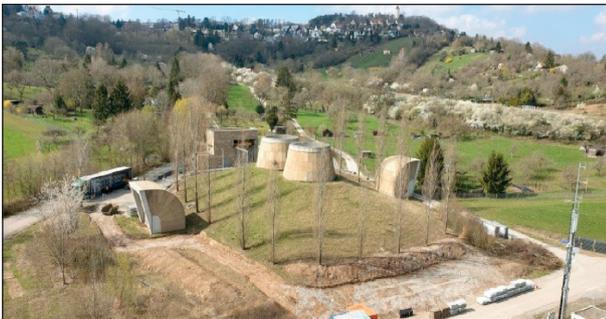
Einbringebauwerk mit Lüftungsbauwerken
